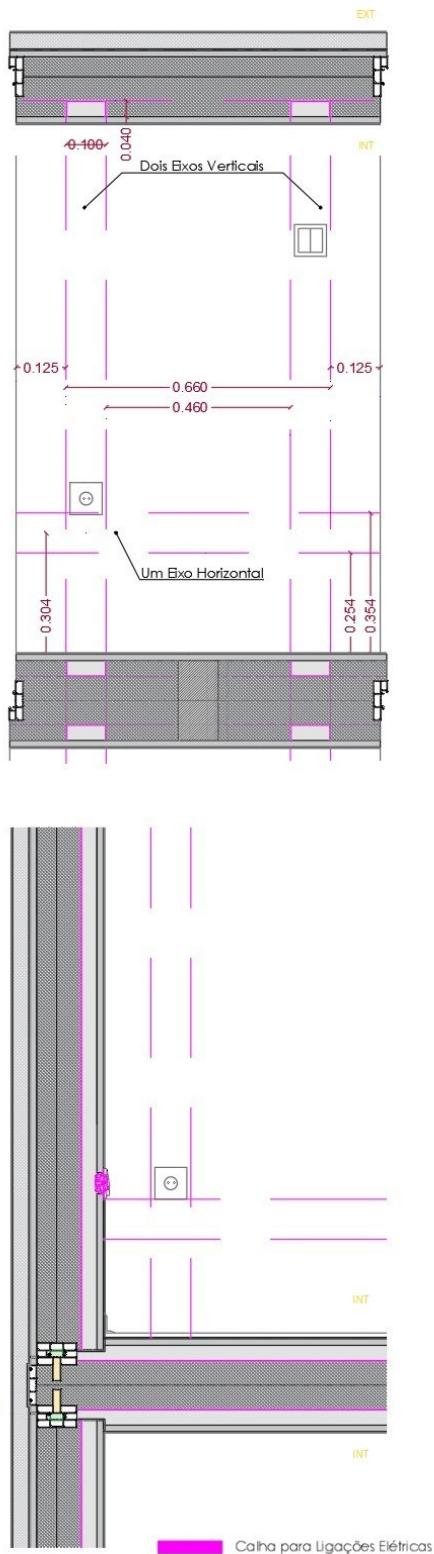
Solução Final – Pormenor construtivo de parede/piso ligações elétricas.
